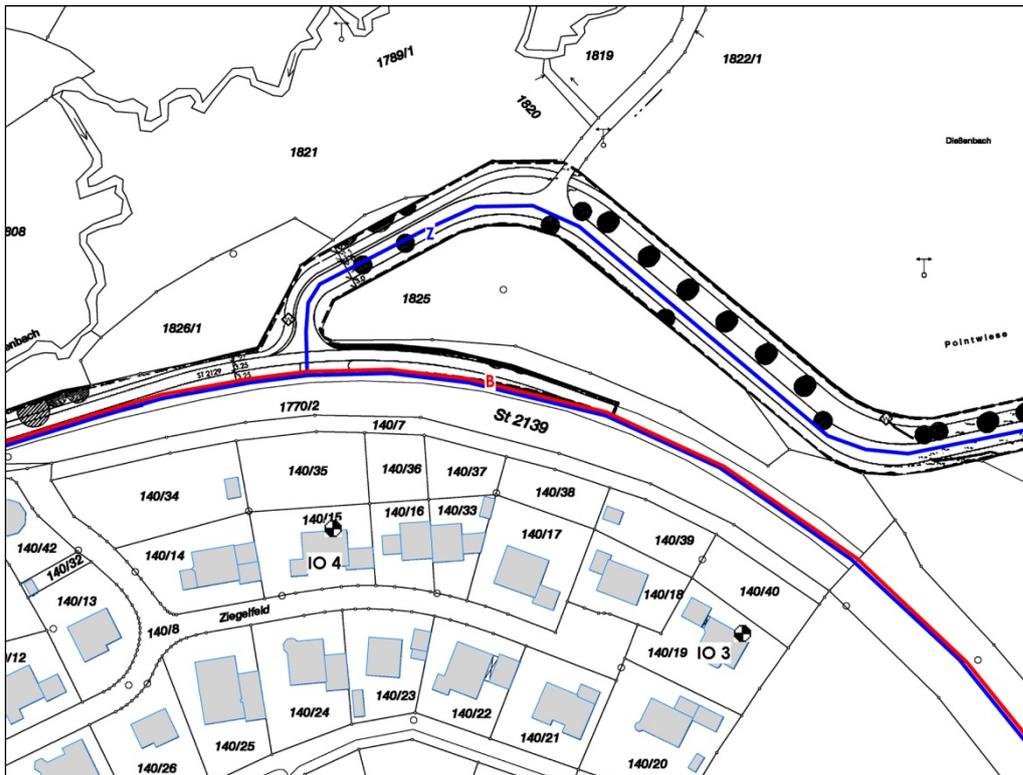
Lageplan mit Darstellung der Schallquellen des öffentlichen Verkehrs
